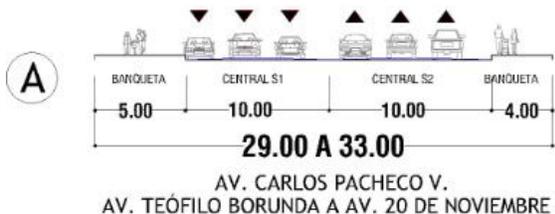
Vista de la Av. Carlos Pacheco Villalobos y su sección vial actual.
